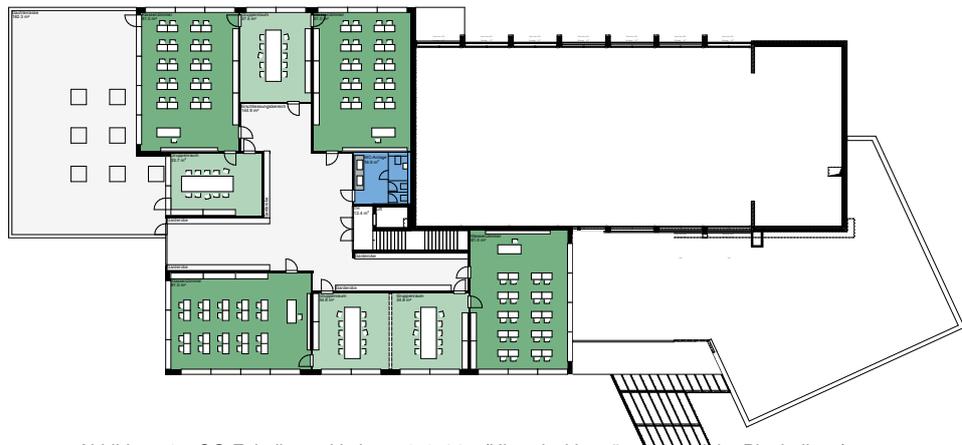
OG Feindispo - Variante 1, 9.4.25 (Hinweis: Vergrößerung siehe Planbeilage)
